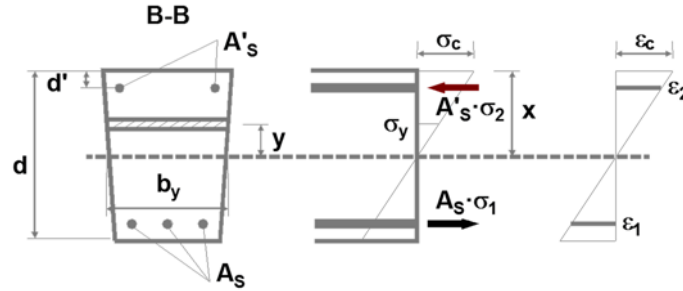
Cálculo de inercia fisurada. Equilibrio en la sección.
